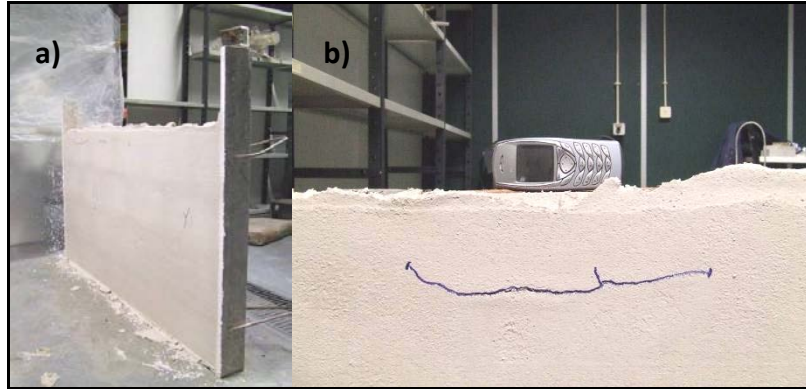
Localização das fissuras na parede P3: a) Vista geral; b) Pormenor.
